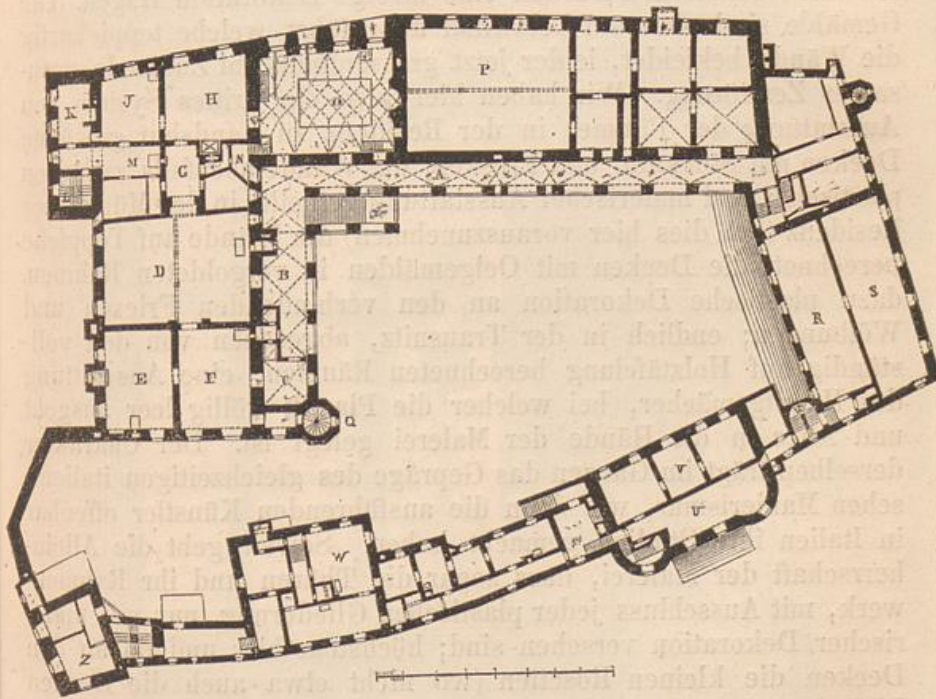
Trausnitz. Grundriss des ersten Stockes.
